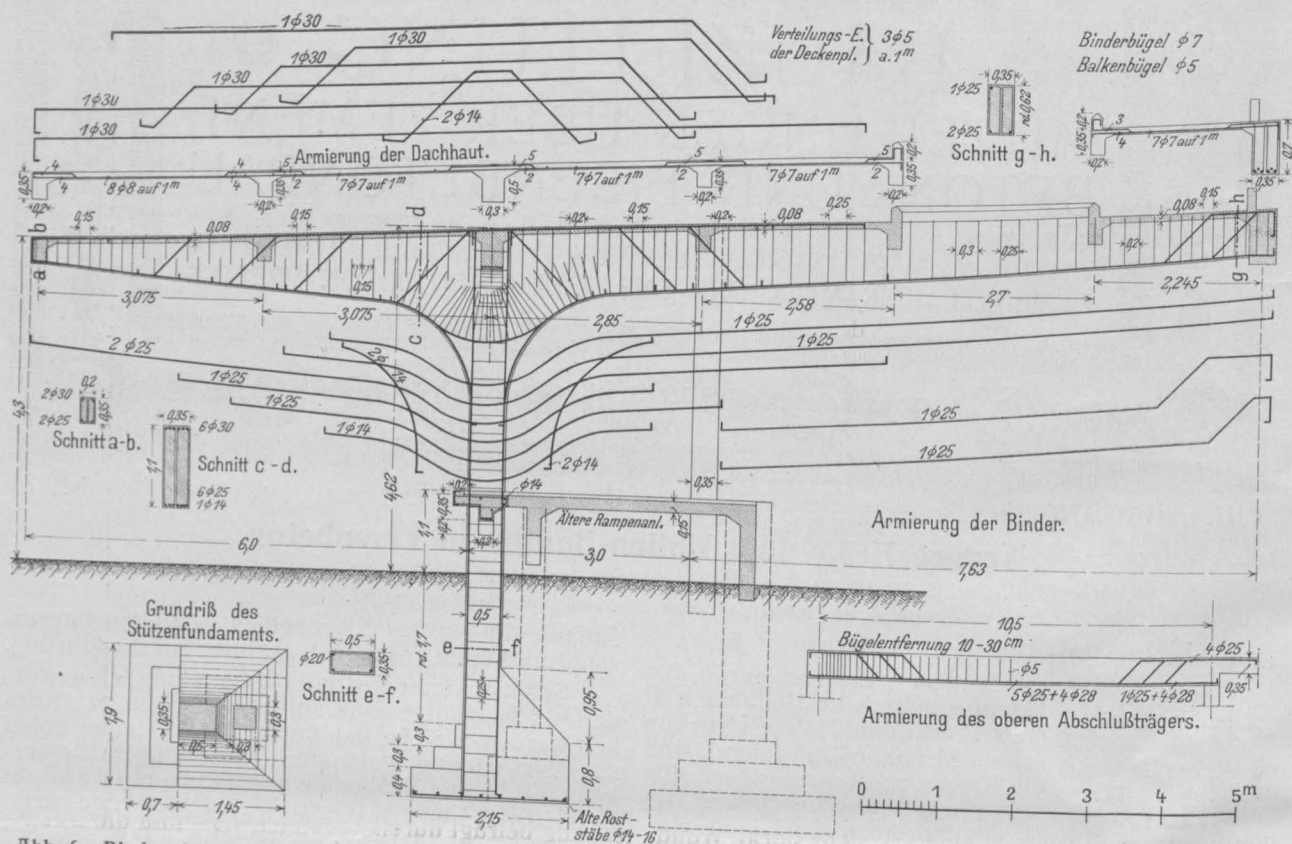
Binder des breiten Teiles der Versandhalle in unmittelbarem Anschluß an die Schwankhalle (vergl. Grundriß Abb. 1).
